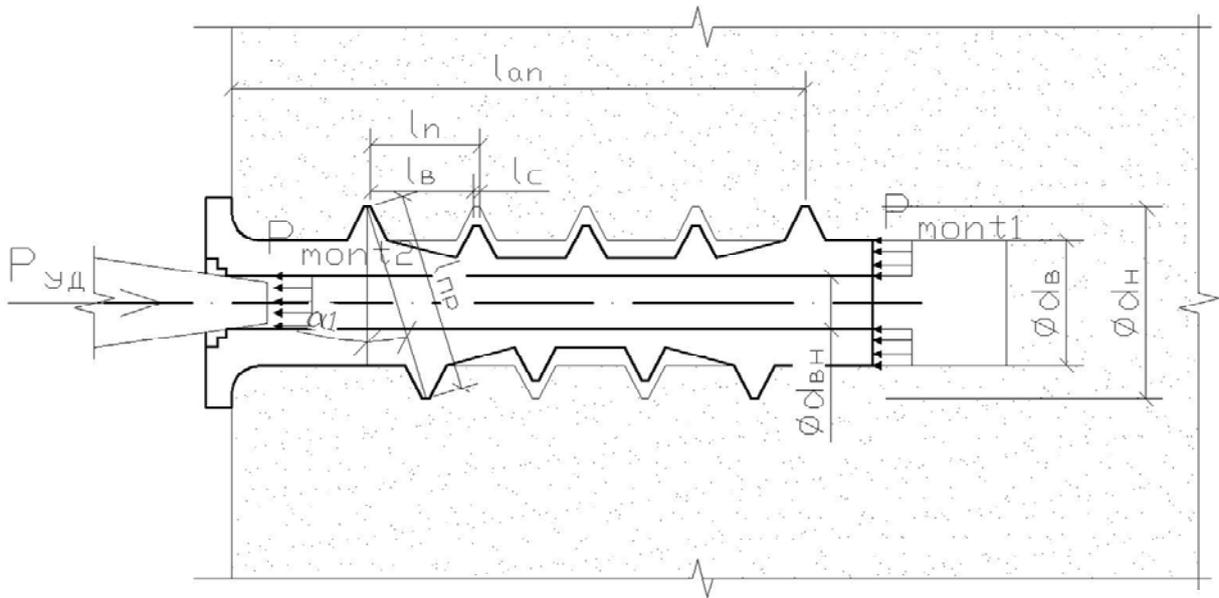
Принципиальная расчетная схема работы устанавливаемого анкера на монтажные нагрузки
